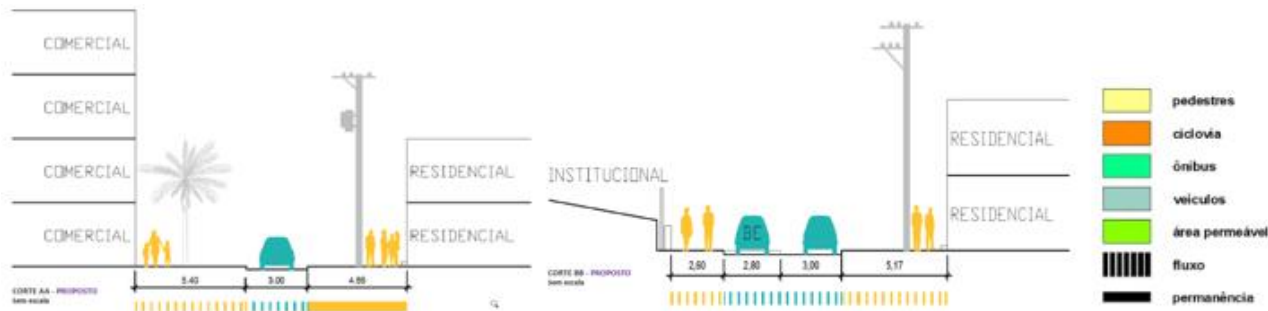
Situação após proposta de intervenção da Rua Taguá por meio de corte esquemático.
